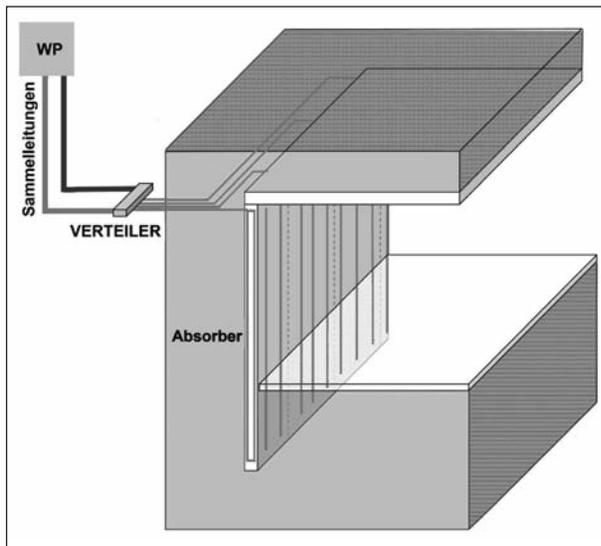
Beispielhafter Aufbau einer Tunnelthermie-Anlage bei einem in offener Bauweise errichteten Tunnelbauwerk (Deckelbauweise) mit Energieschlitzwänden. Die Absorberleitungen werden dabei im Kopfbereich der Schlitzwände herausgeführt und seitlich des Deckels bis zum Verteiler (z. B. in einem Betriebsraum oder einem Schacht situiert) geführt. Vom Verteiler verlaufen die Sammelleitungen bis zum Abnehmer
